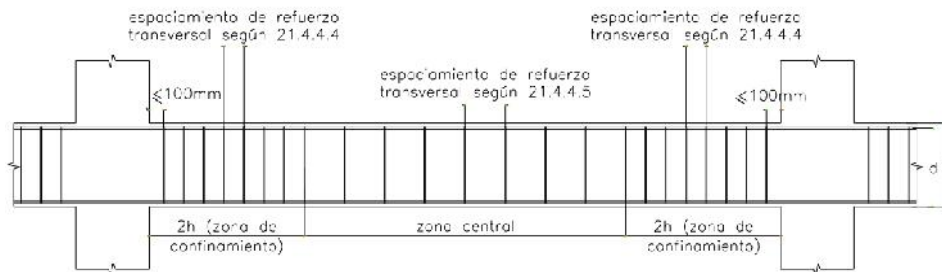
Requerimientos de estribos en vigas (Norma E.060)
